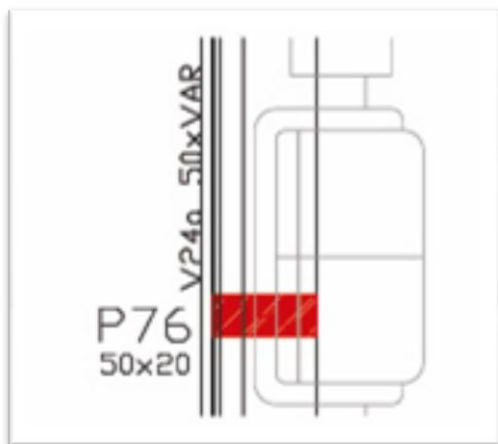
Planta baixa intersecção pilar com esquadria.
